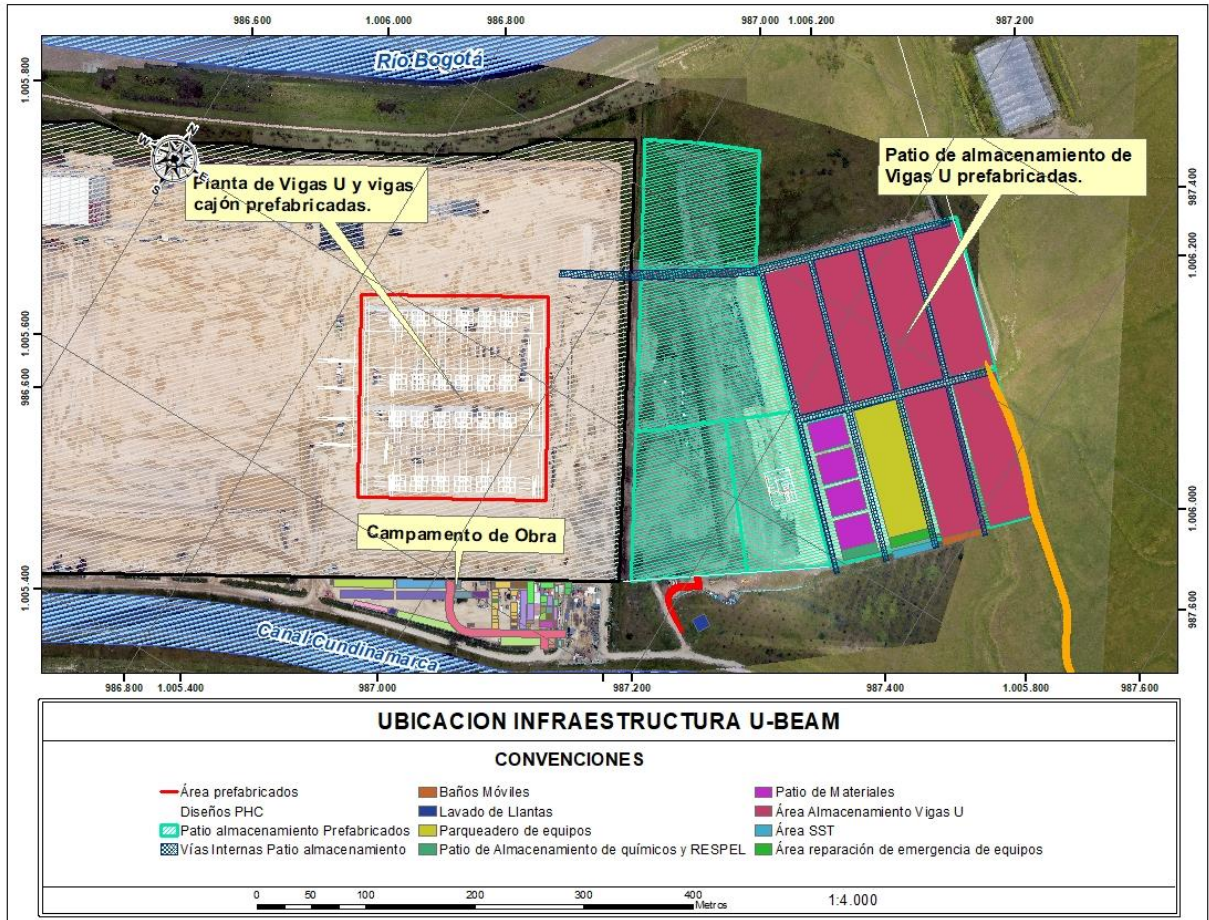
Esquema la ubicación de la planta de producción de vigas U
